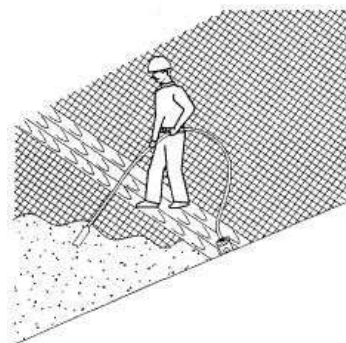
Уплотнение уложенной бетонной смеси
